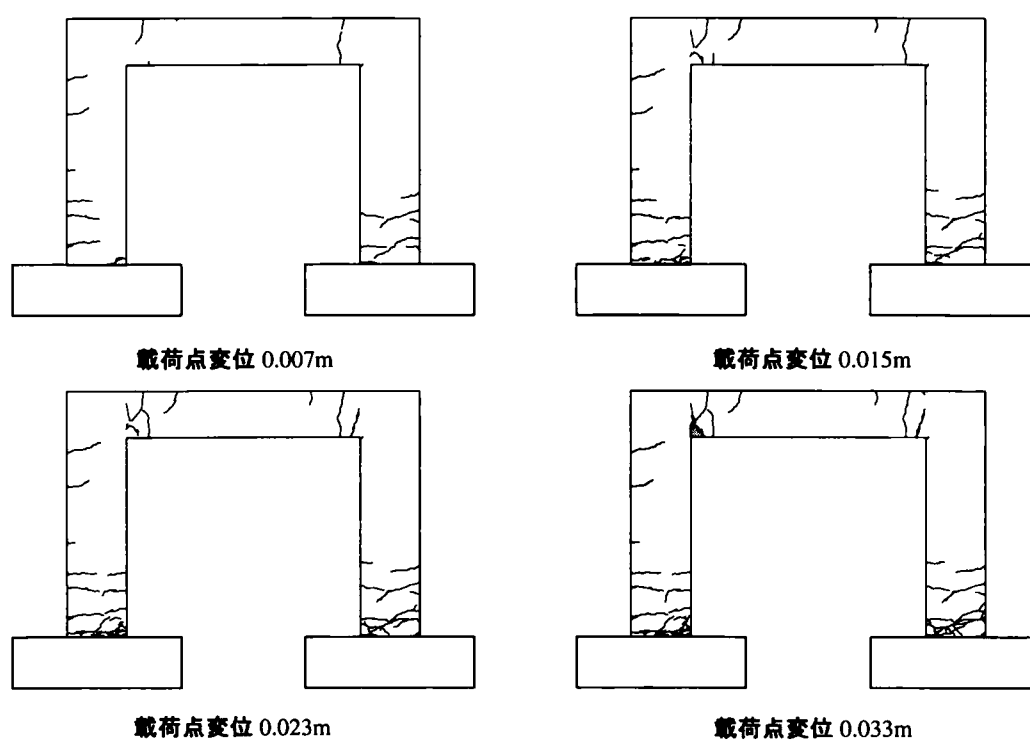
UBRC-1 供試体のひび割れの進展状況
